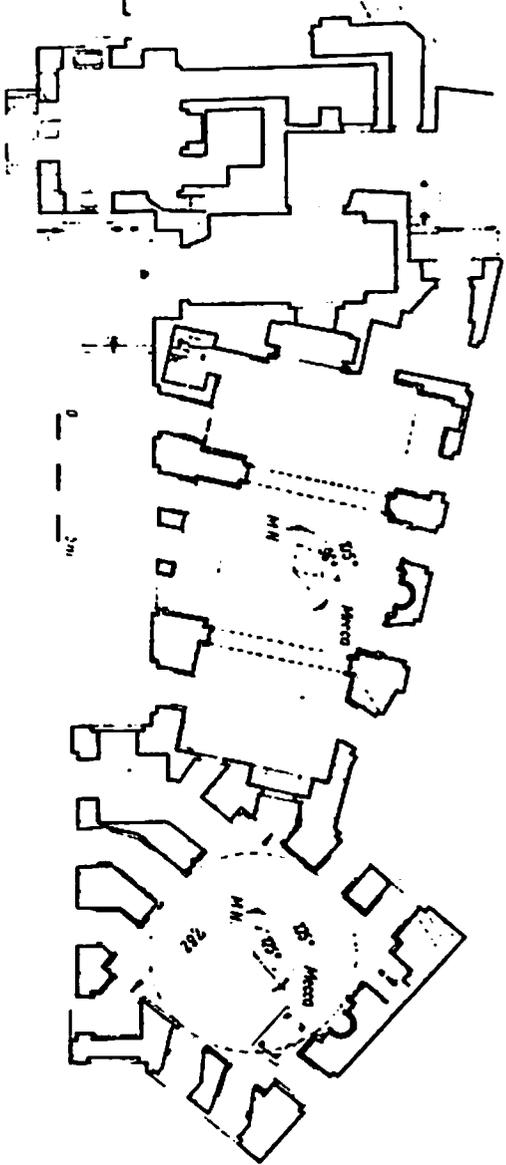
مسقط أفقى لقبة قانصوه أبو سعيد عن هيئة الآثار
